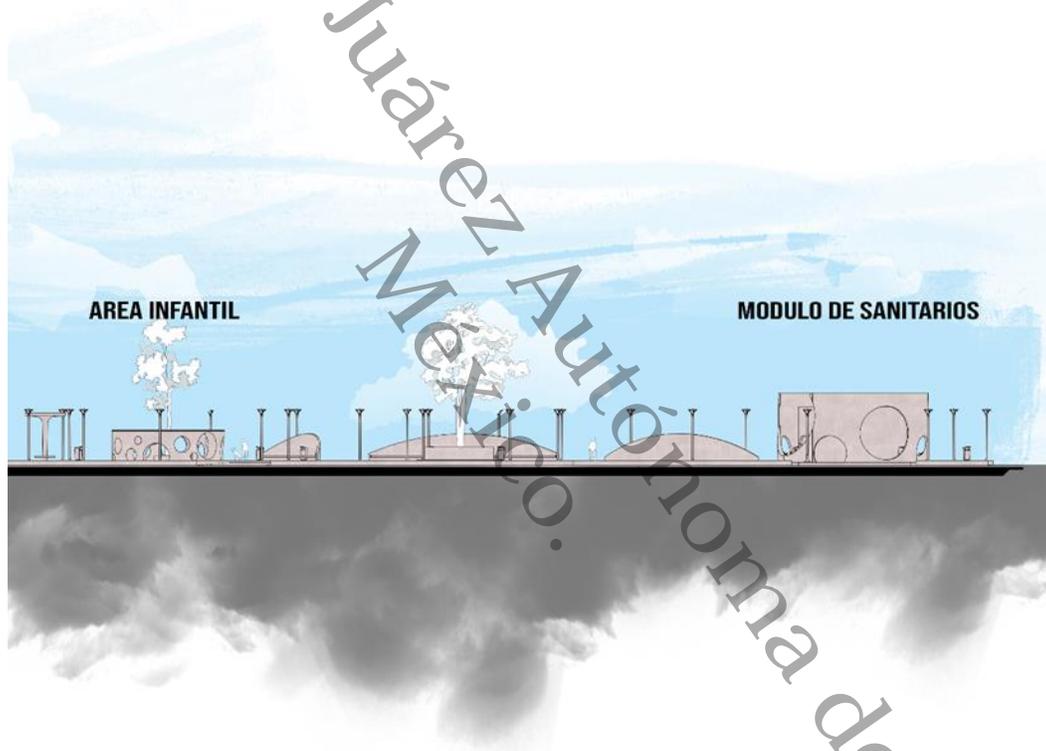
Alzado sección C. [Figura]. Fuente: Autores (2024).
